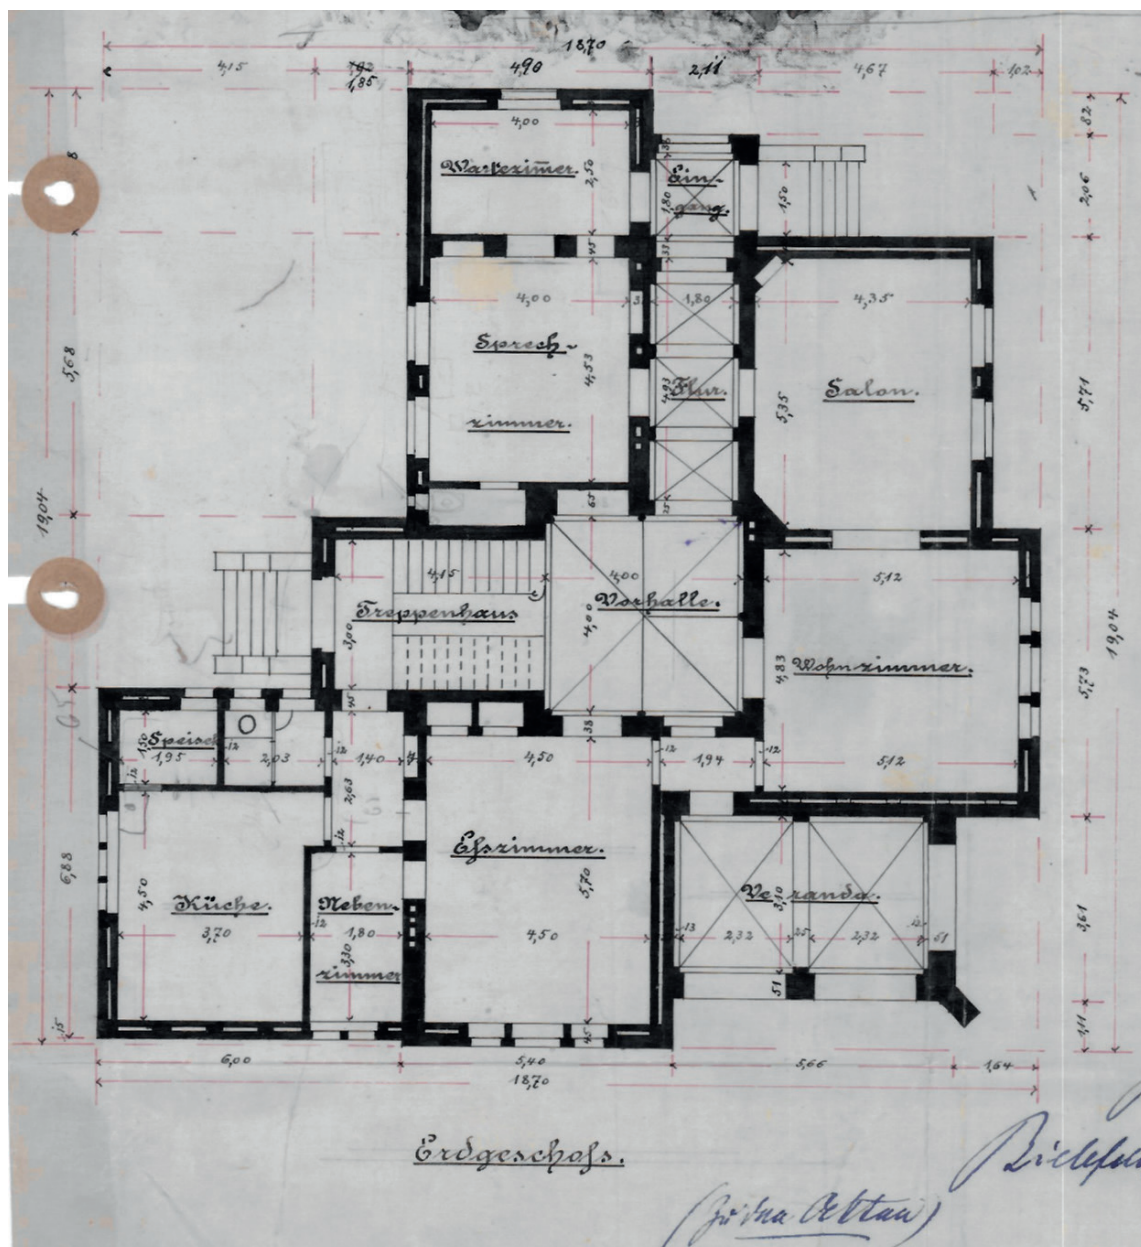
Grundriss des Erdgeschosses (EG) der Villa Schlüter(historisch)
